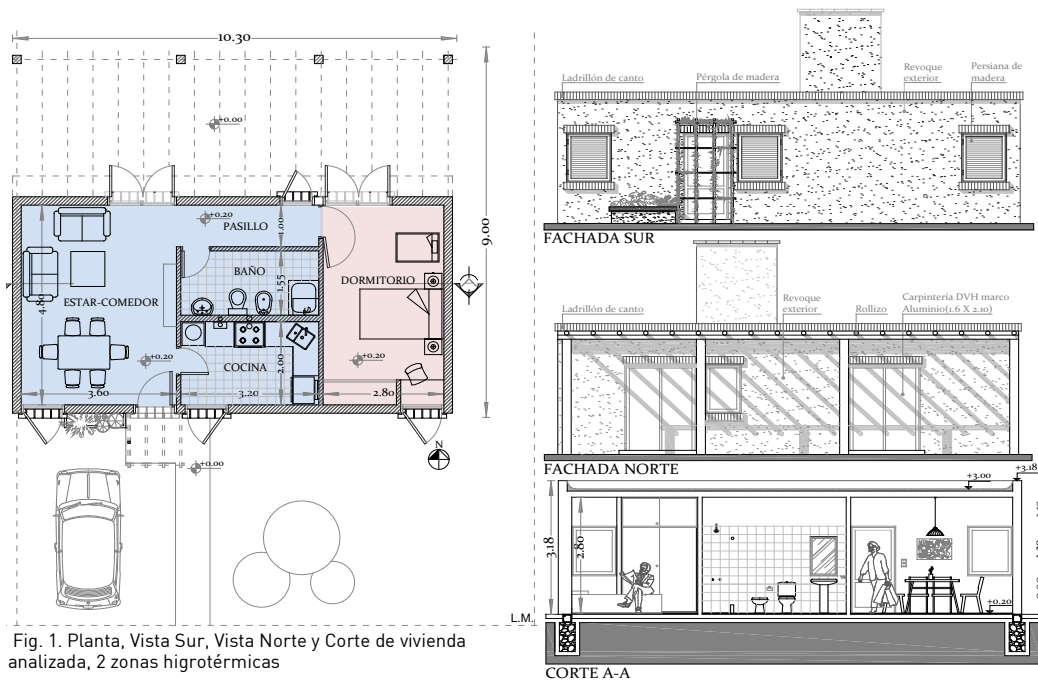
Planta, Vista Sur, Vista Norte y Corte de vivienda analizada, 2 zonas higrotérmicas
